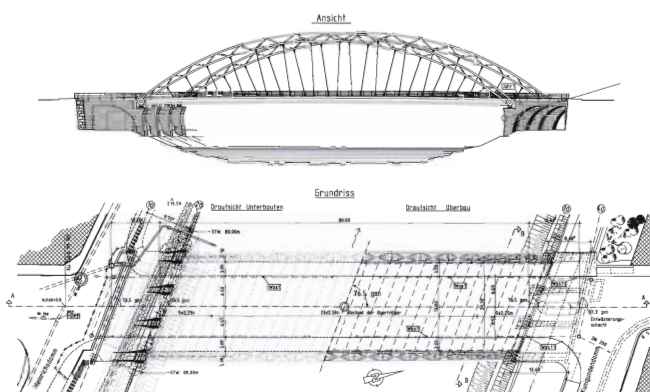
Ansicht und Grundriss der Luitpoldbrücke
